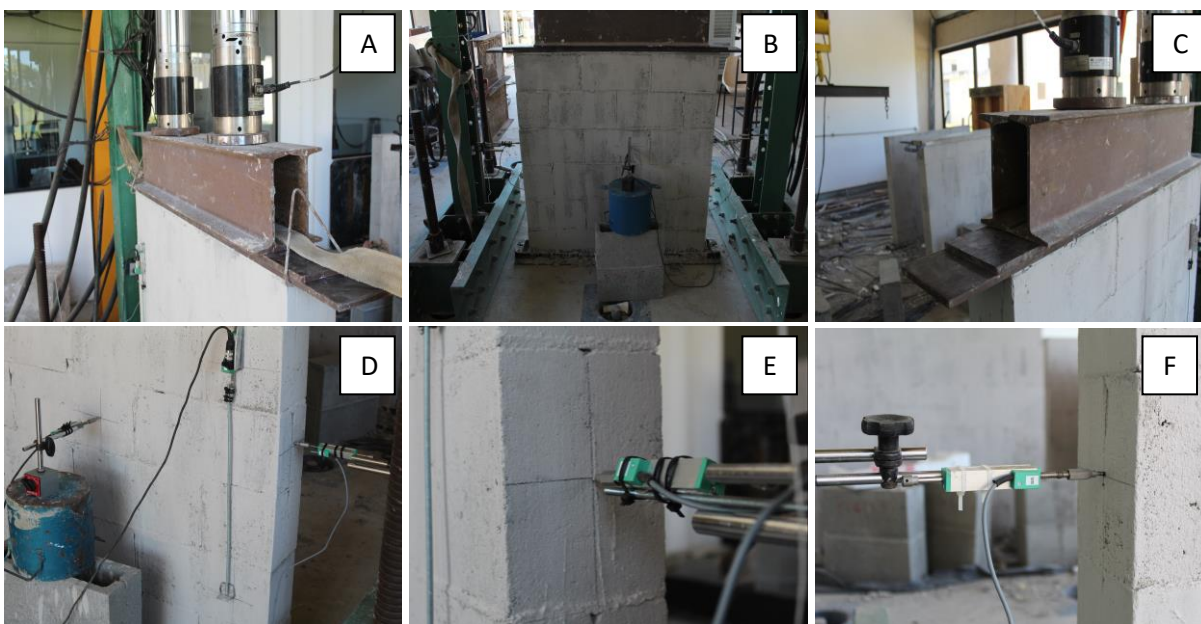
Preparação para aplicação de carga nas miniparedes com viga convencional
